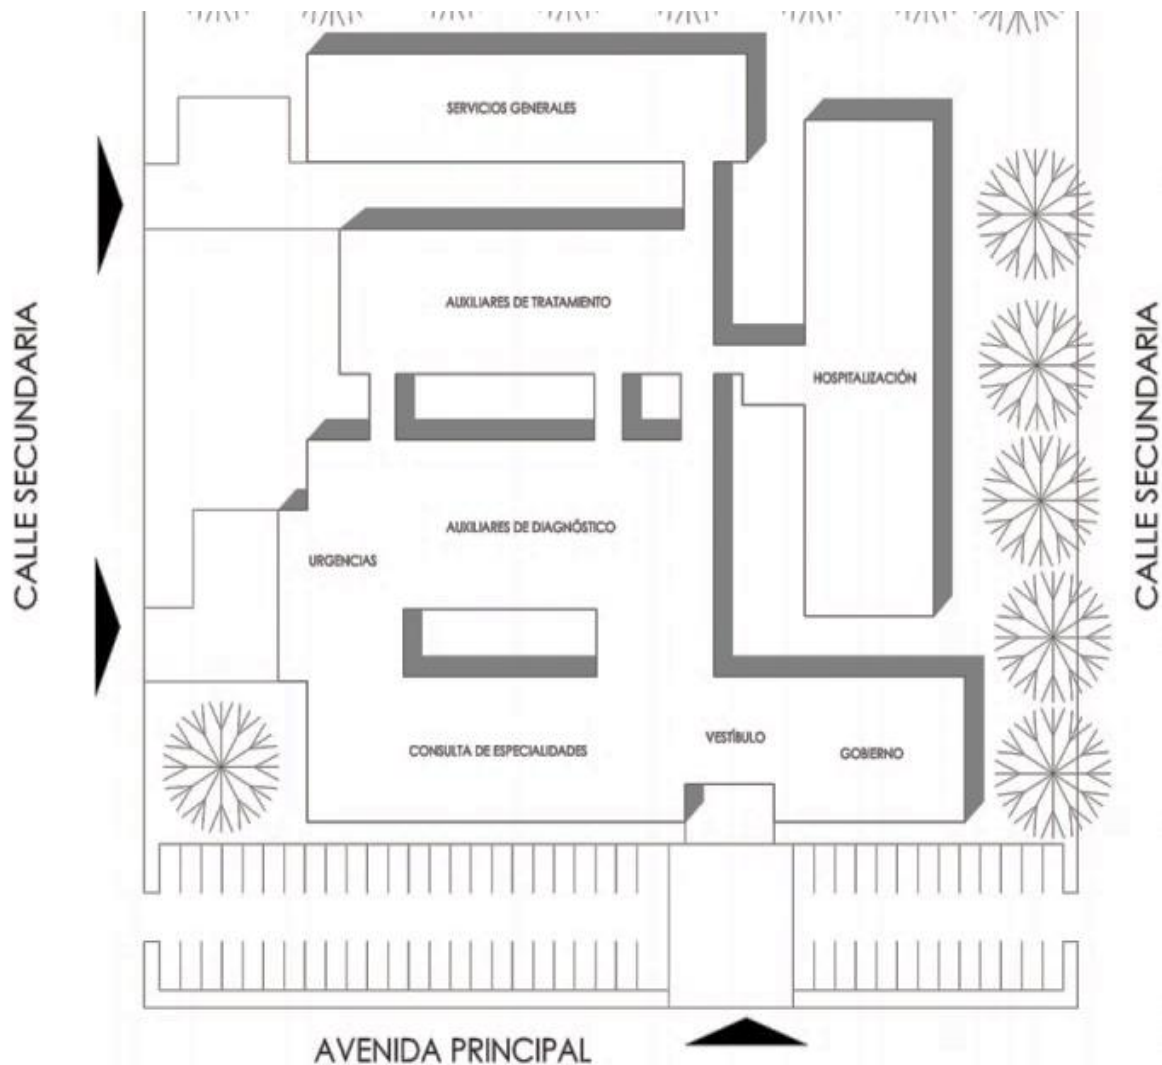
(Secretaría de salud, 2006). Planta de conjunto.
